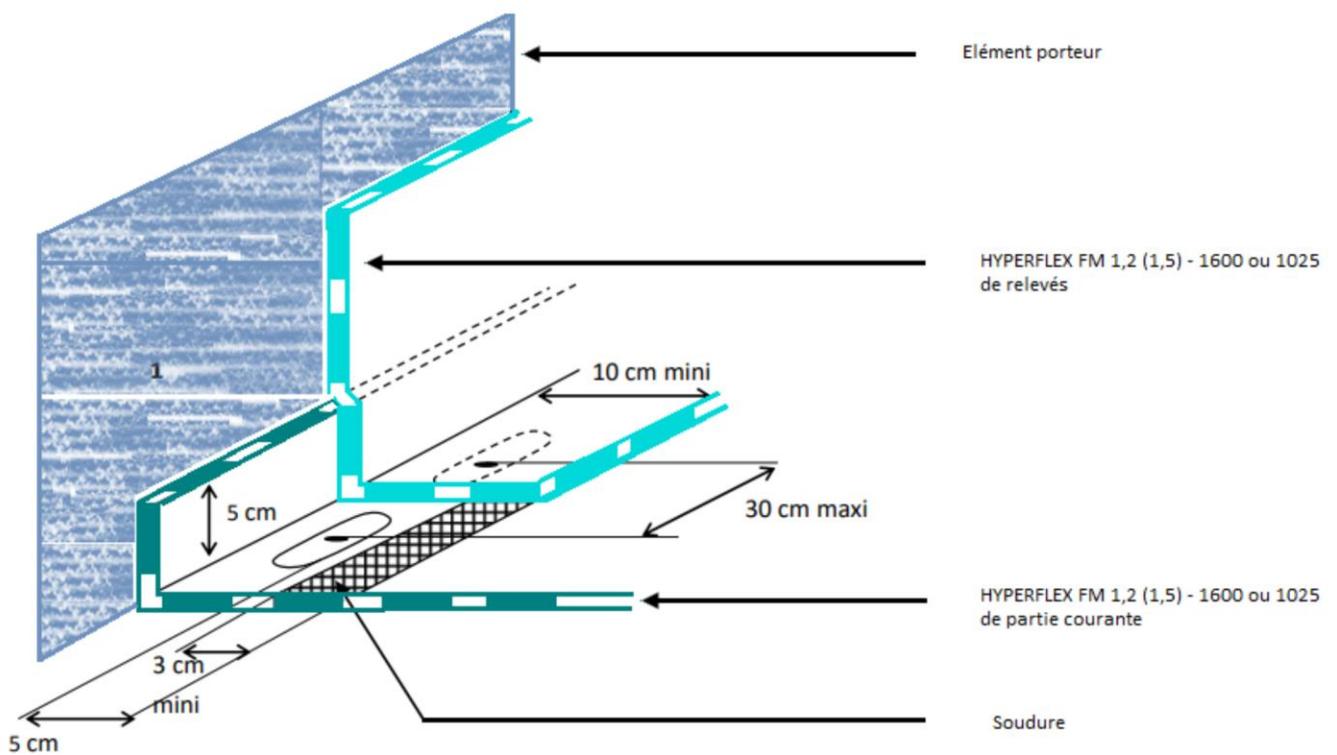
Relevés : Recouvrements et soudures – dimensions à respecter
